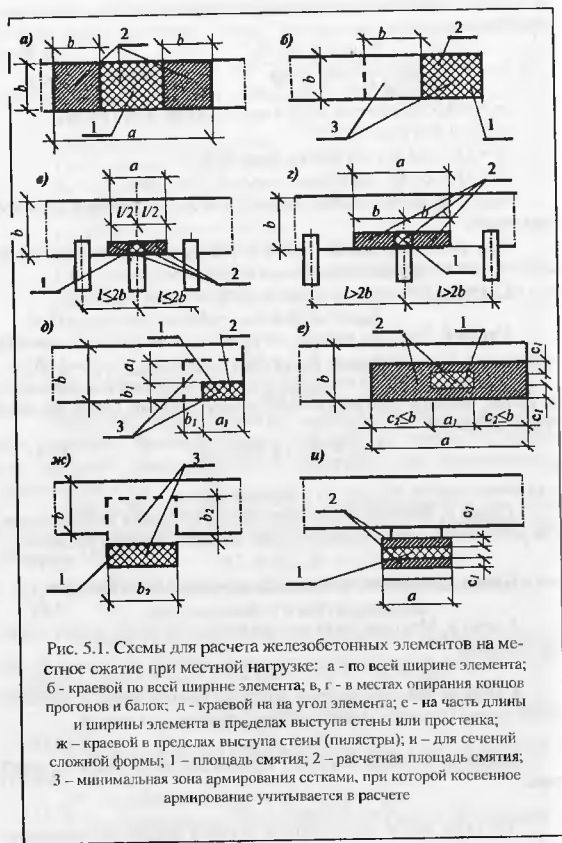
Схемы для расчета железобетонных элементов на местное сжатие при местной нагрузке: а - по всей ширине элемента; б - краевой по всей ширине элемента; в, г - в местах опирания концов прогонов и балок; д - краевой на угол элемента; е - на часть длины и ширины элемента в пределах выступов стены или простенка; ж - краевой в пределах выступа стены (пиллястры); и - для сечений сложной формы; 1 - площадь смятия; 2 - расчетная площадь смятия; 3 - минимальная зона армирования сетками, при которой косвенное армирование учитывается в расчете
